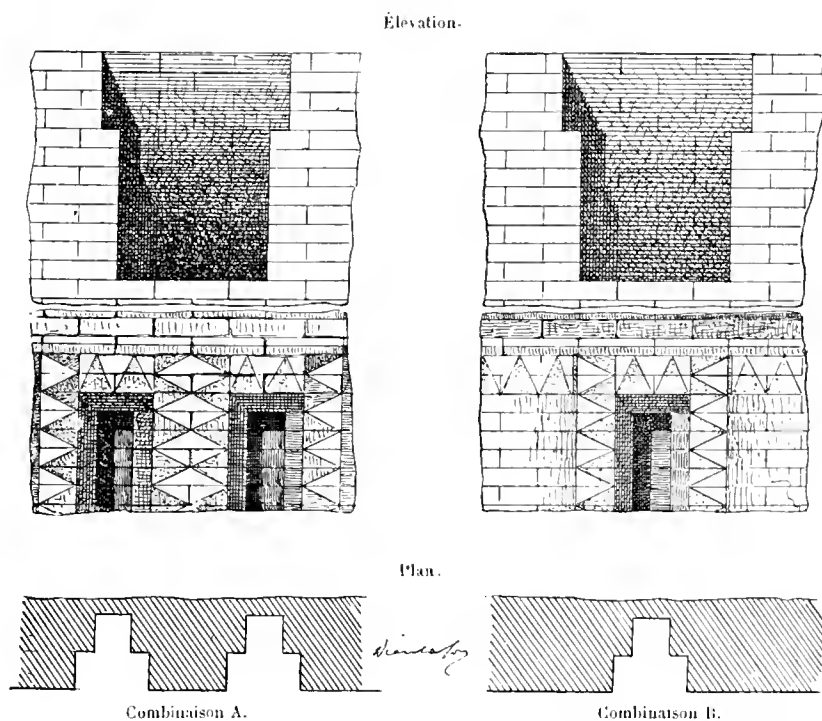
RESTAURATION DES ARCHERS. — ENCADREMENTS ET RAINURES DIVISOIRES.
